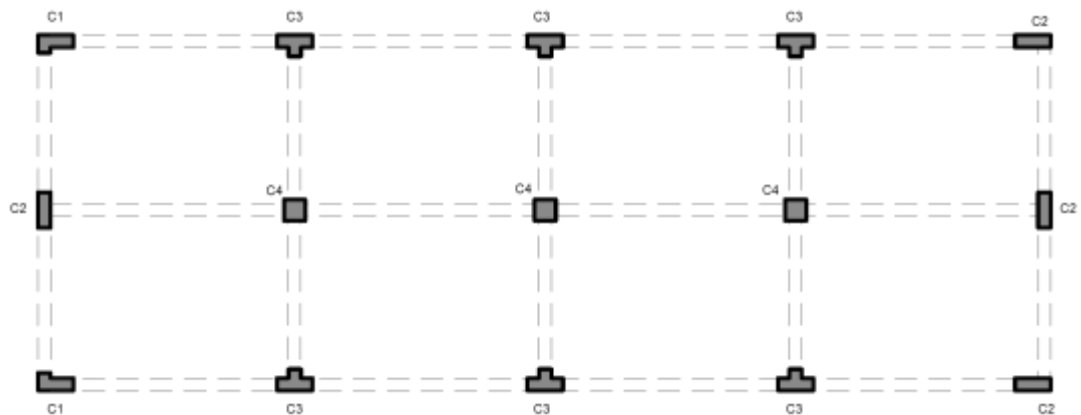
Pre dimensionamiento columnas bloque sector.
